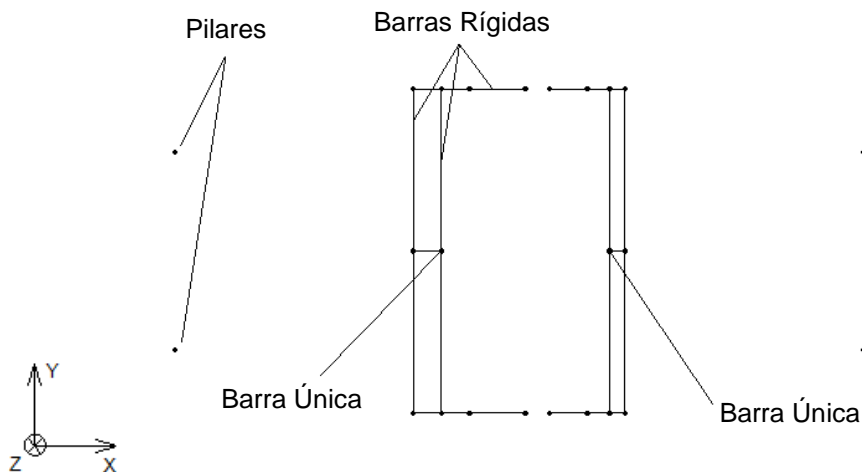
Vista em planta, a partir do 37º piso, do núcleo central com aberturas e dos pilares laterais
